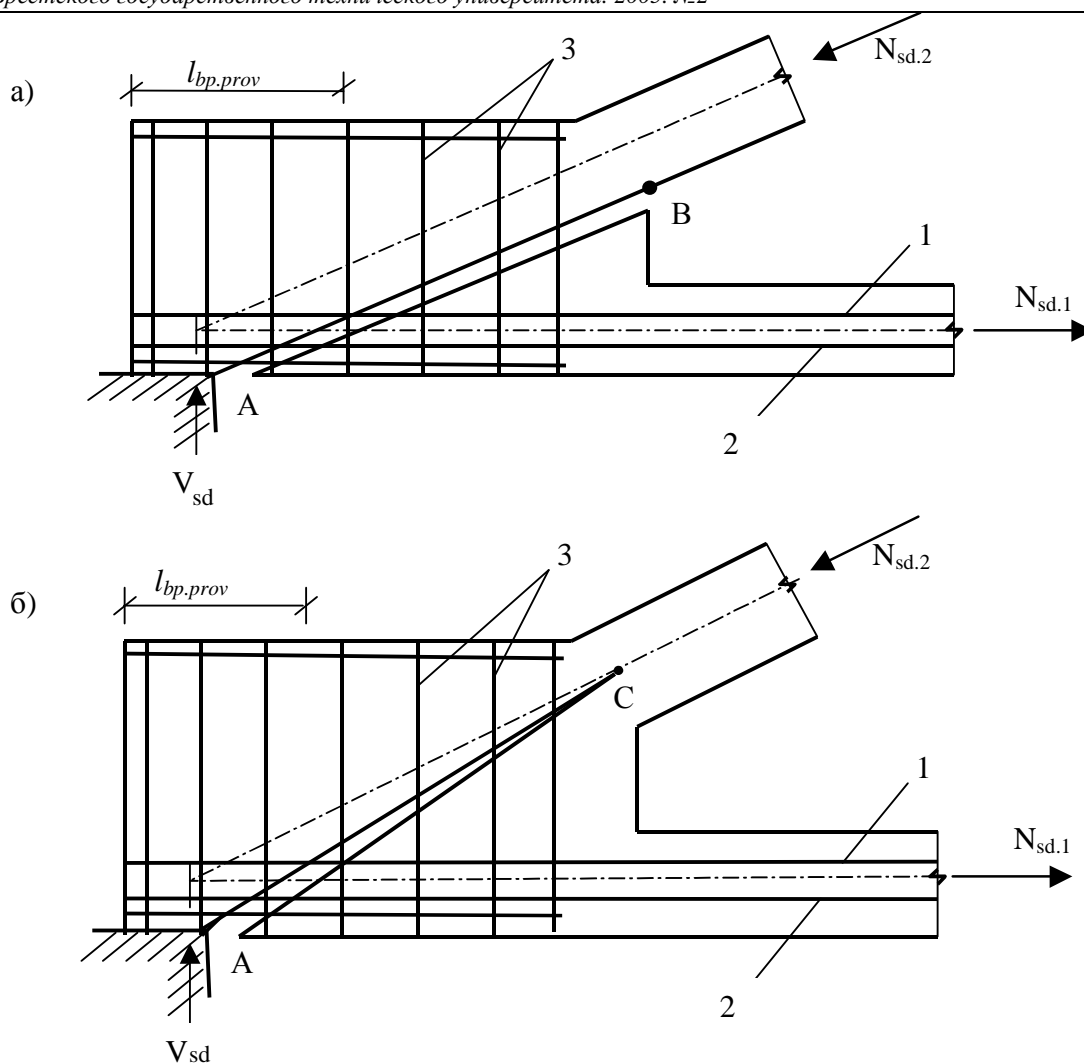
Виды разрушения опорных узлов: а – разрушение узла от отрыва по наклонному сечению АВ; б – разрушение узла от изгиба в наклонном сечении АС; 1 – продольная напрягаемая арматура нижнего пояса; 2 – продольная ненапрягаемая арматура опорного узла; 3 – поперечная арматура опорного узла.
